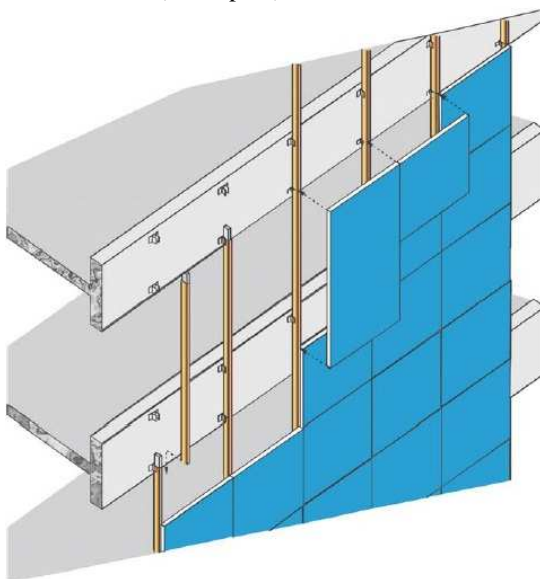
Fachada Sistema Híbrido ou Coluna-Folha.
